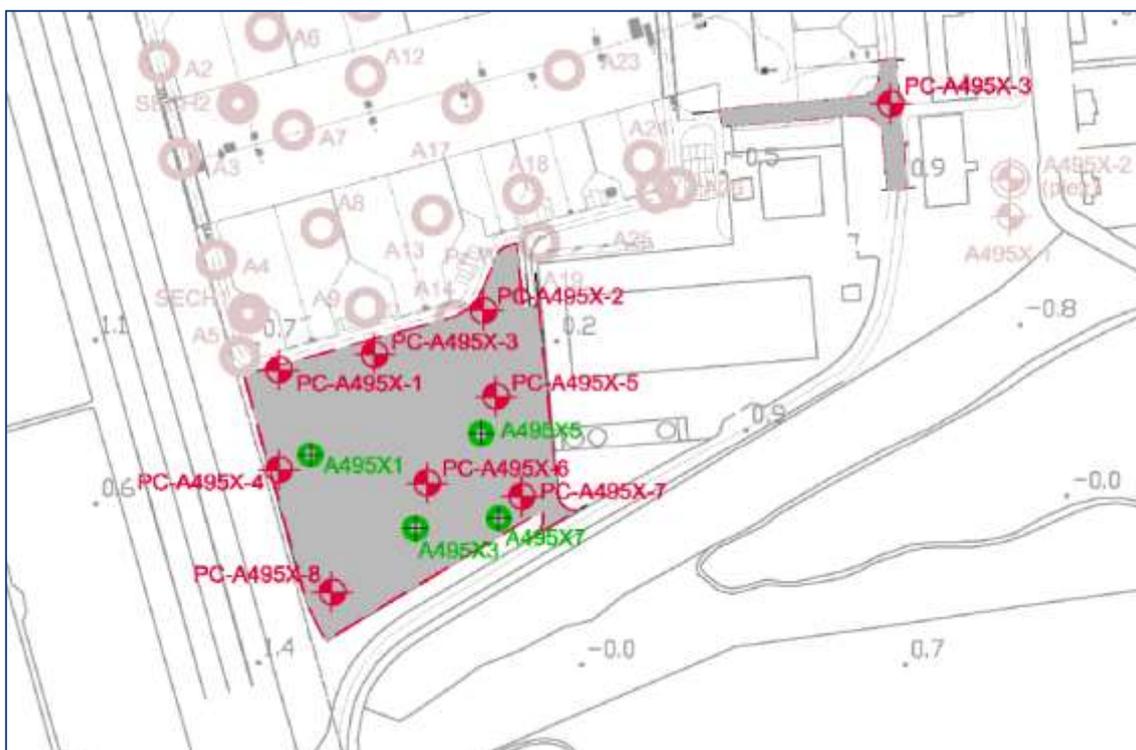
Stralcio planimetrico con l'ubicazione dei punti di indagine nell'area della nuova Isola Seram
